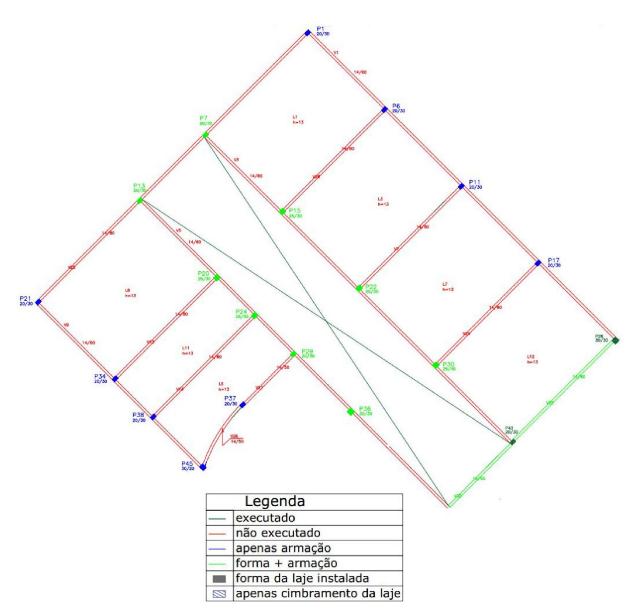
Mapa iluminado da ASA ESQUERDA do pavimento de cobertura.
